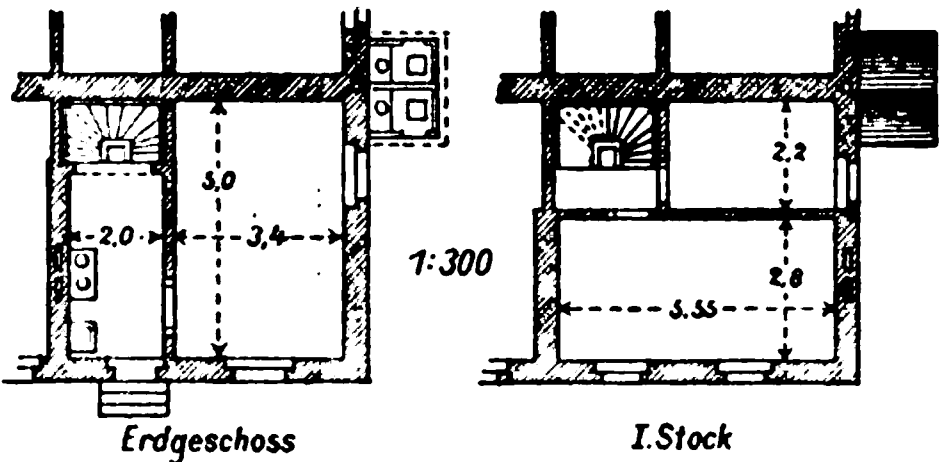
Grundriss der Mühlhäuser Vierhäuser.
